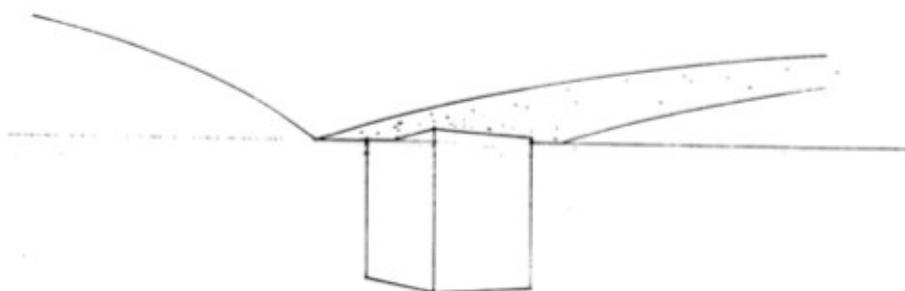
Croqui de Niemeyer: encontro da ponte com os blocos de fundação, o afastamento do perfil da ponte do bloco de fundação garantiria a sensação de flutuação da ponte sobre o lago. Fonte: DE – DVO – NOVACAP, 1969.
